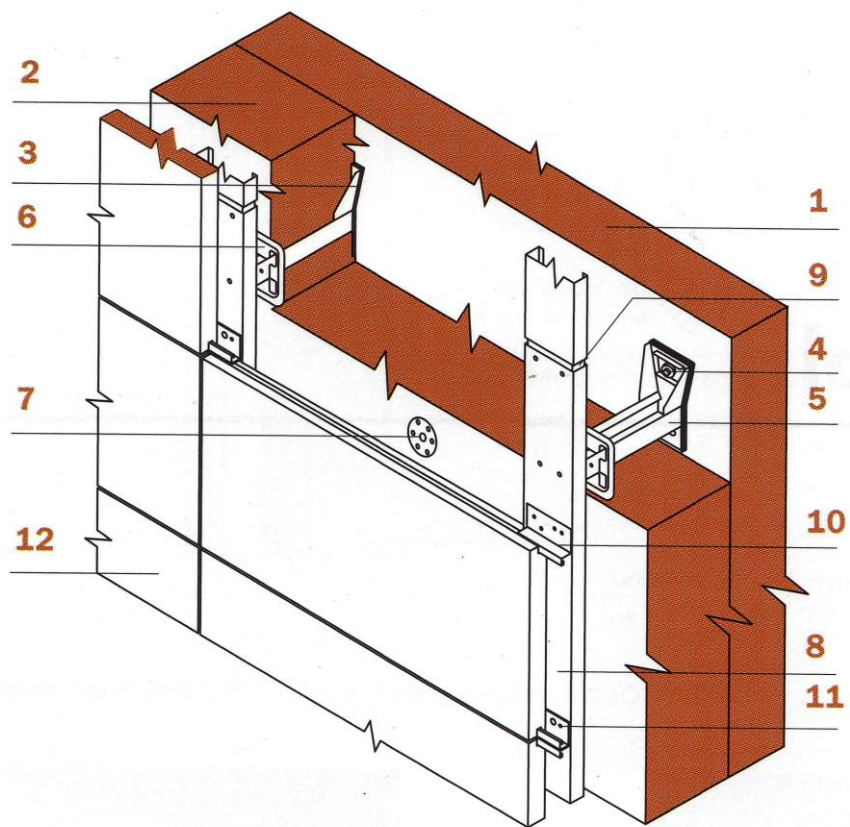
Фасадная система с вентилируемым воздушным зазором:
